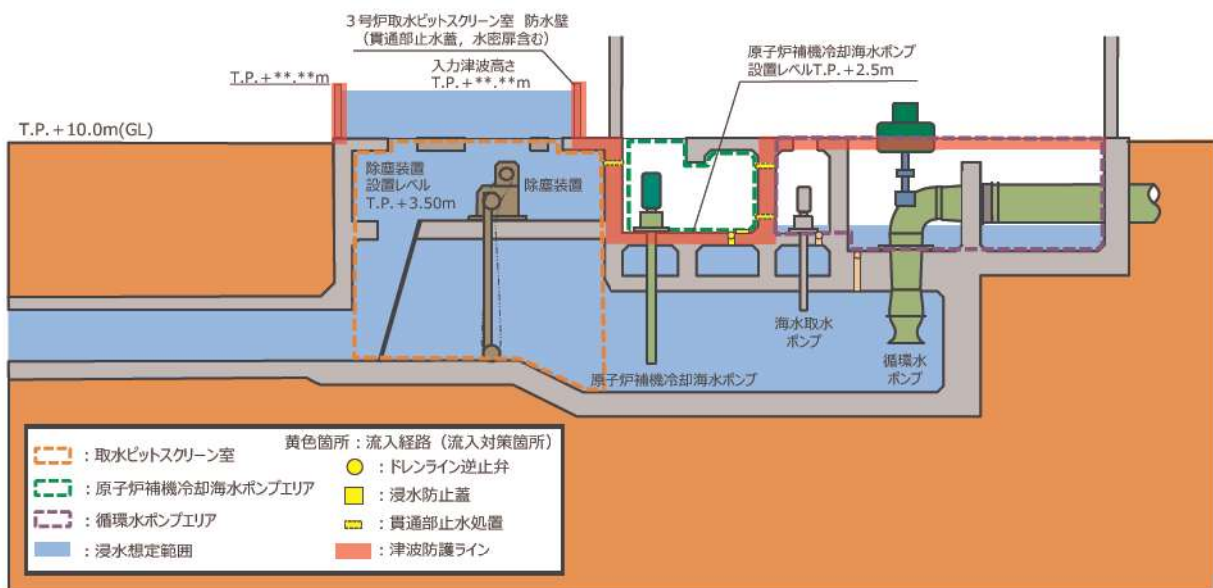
3号炉取水系統 流入対策配置図 (A-A 断面図)
